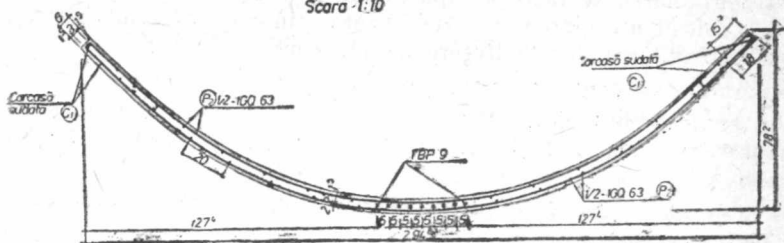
b. Armarea elementului UPH-15/3.
